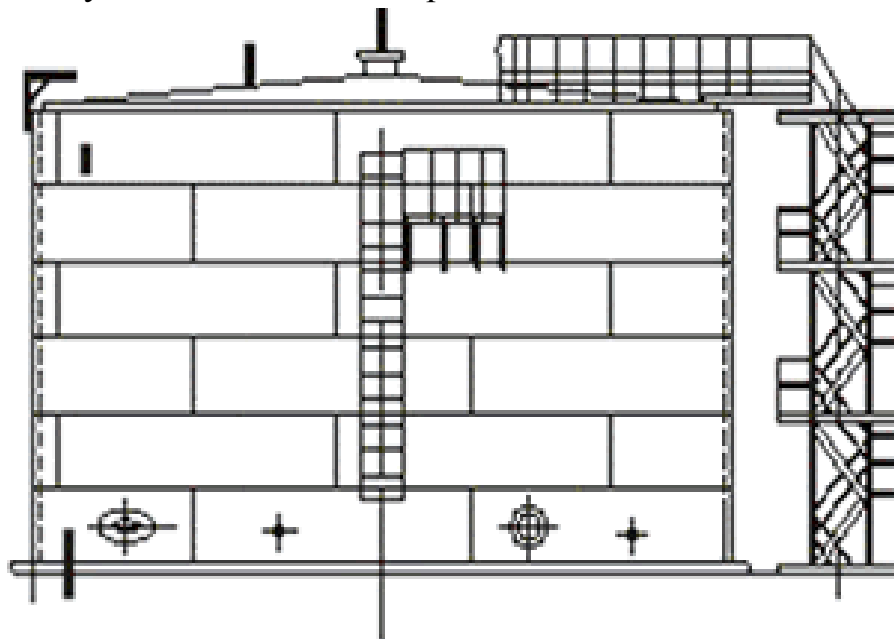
Цилиндрический сварной стальной резервуар с конической крышей и шахтной лестницей
